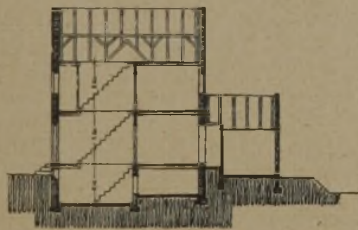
Querschnitte zu obigen Grundrissen. M. 1:400.
